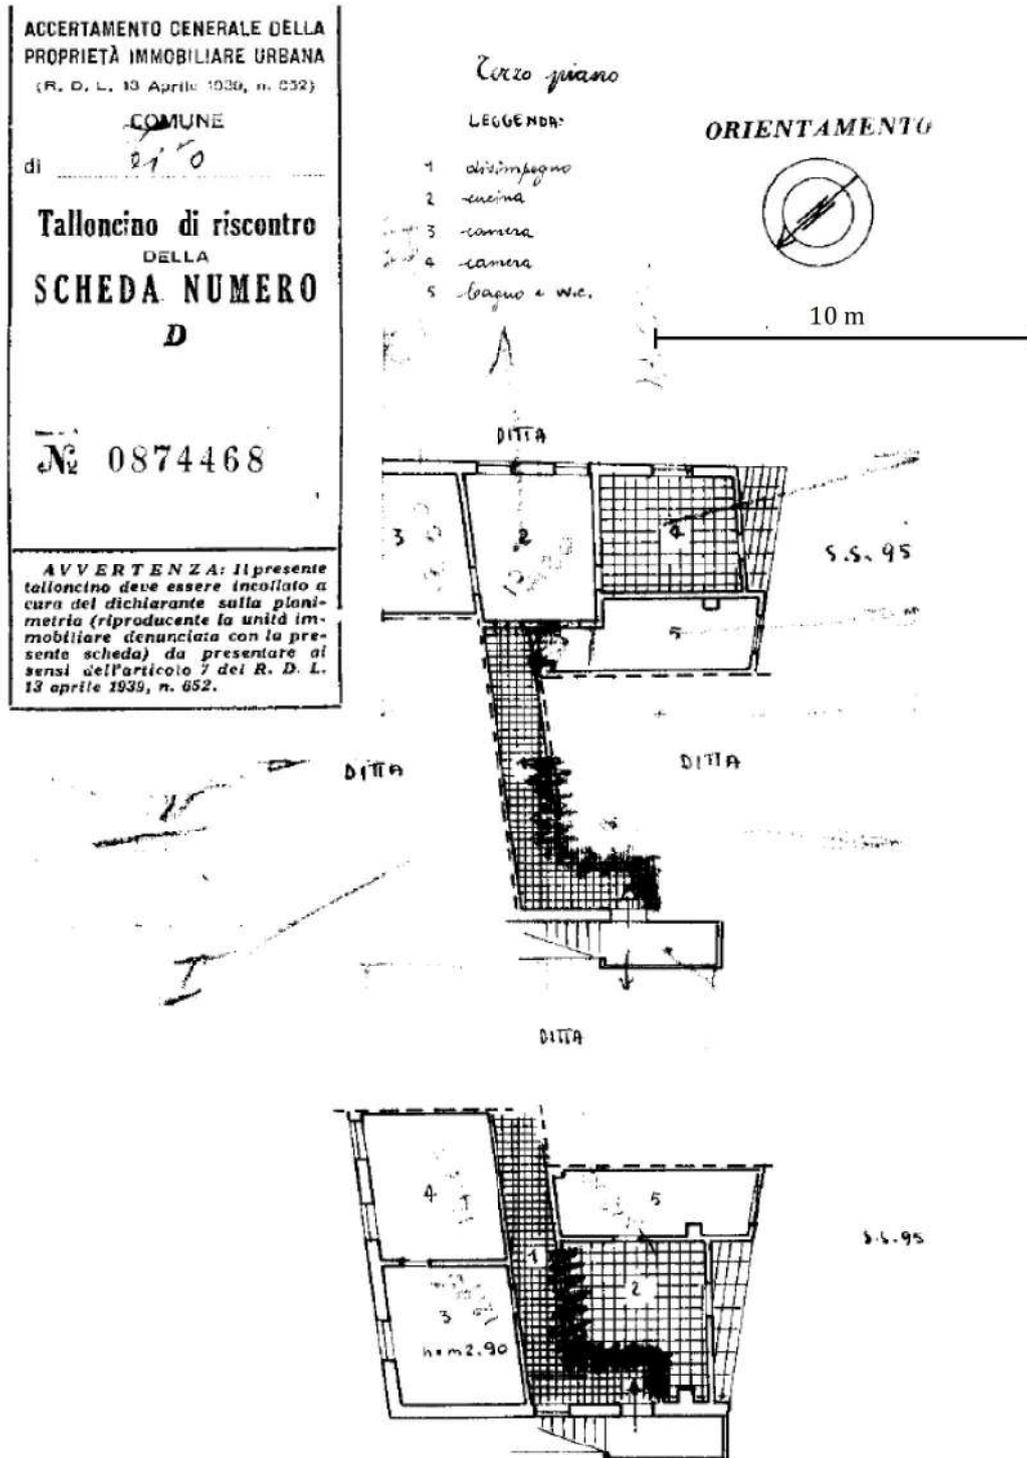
Estratto Planimetria Catastale - Civile abitazione Foglio ■ Part. ■ Sub ■ - Piano 2°
